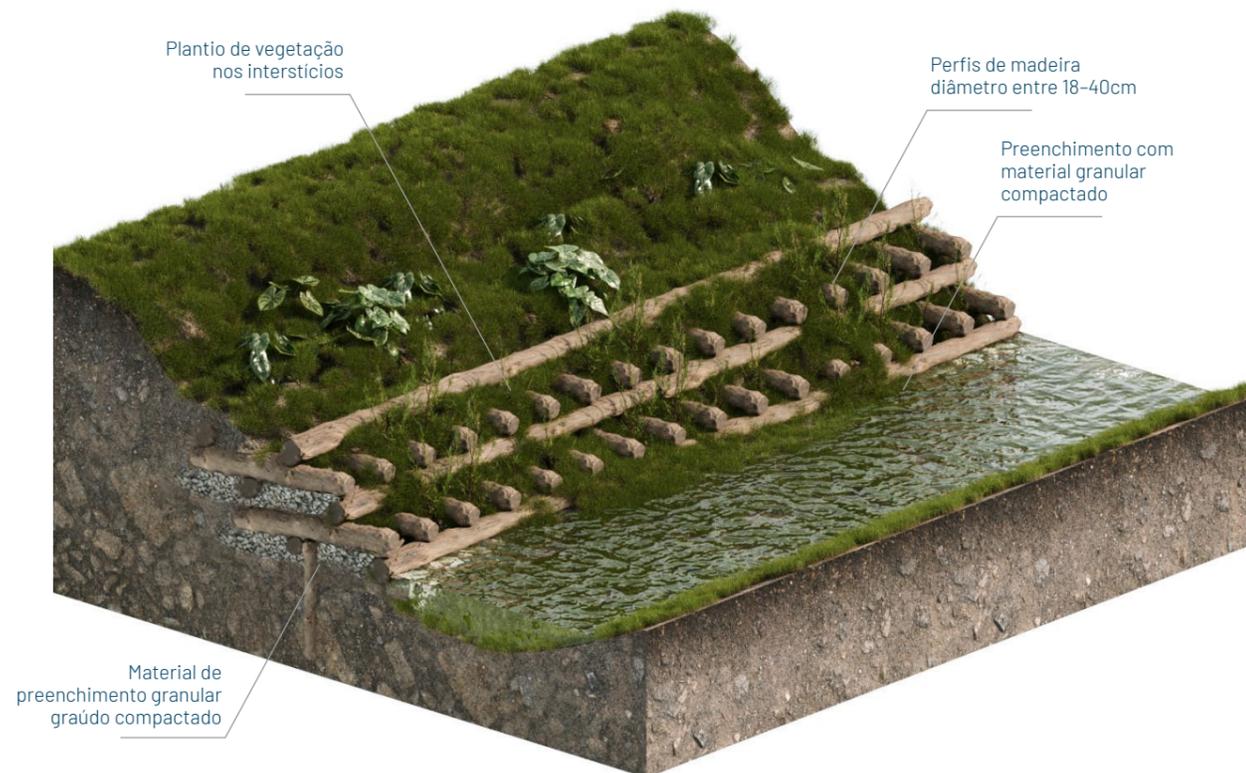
Muro de suporte vivo em madeira tipo cribwall (Fonte: Guajava. Adaptado de Helgard Z., 2007).
